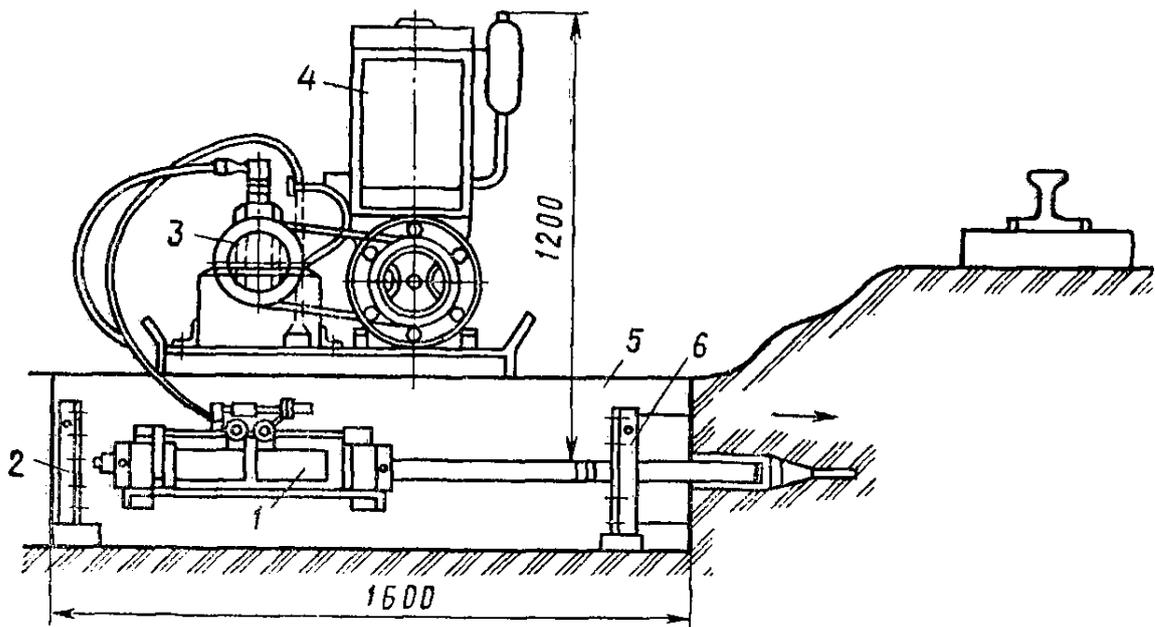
Установка для прокола грунта: 1 - рабочий -цилиндр гидравлического пресса; 2 - упор; 3 - гидравлический пресс; 4 - бензиновый двигатель; 5 - рабочий котлован; 6 - направляющее устройство
